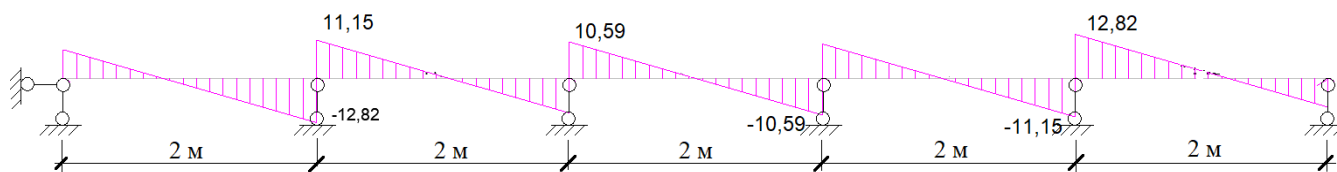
Поперечные усилия расчетной схемы профлиста ($кН$)
